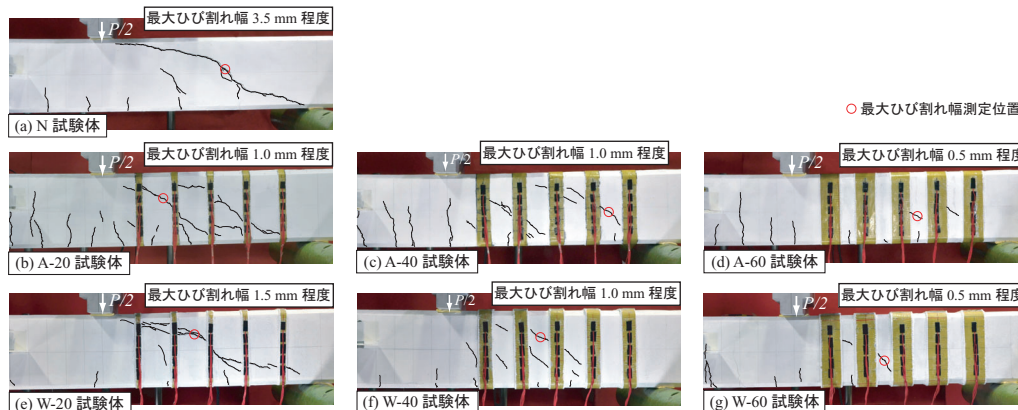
試験体の最大荷重時におけるひび割れ性状
